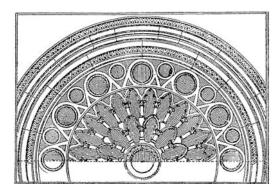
Sigüenza. Catedral, detalle del rosetón del transepto sur (Street [1865] 1926)
